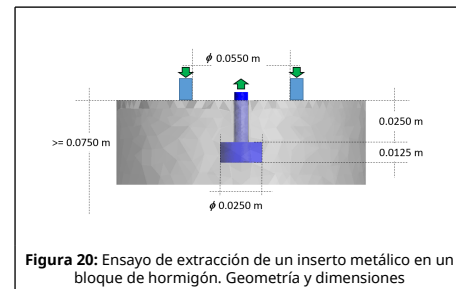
Ensayo de extracción de un inserto metálico en un bloque de hormigón. Geometría y dimensiones
